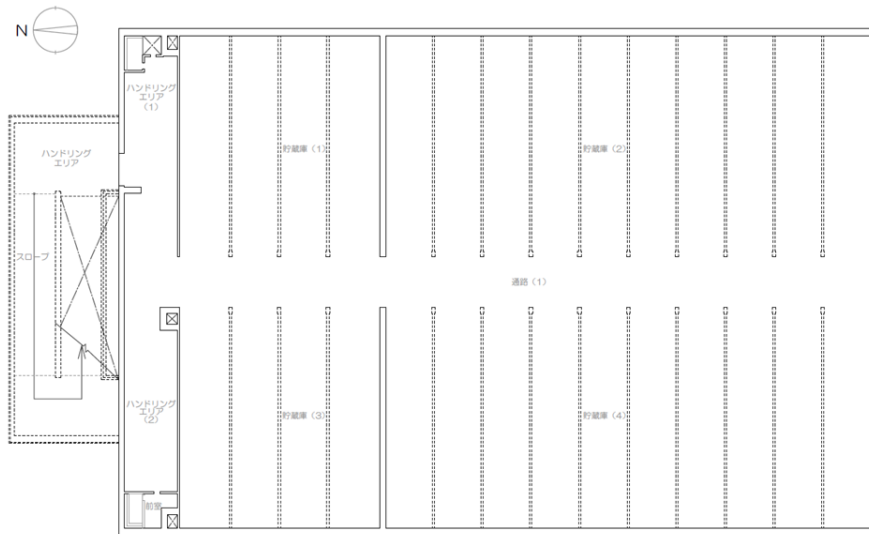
確認事項の対象となる機器の配置を示した図 4階平面図 (5/6)
